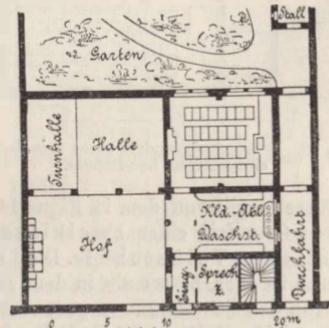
Erdgeschoßgrundriß einer belgischen Landschule (s. S. 82).
